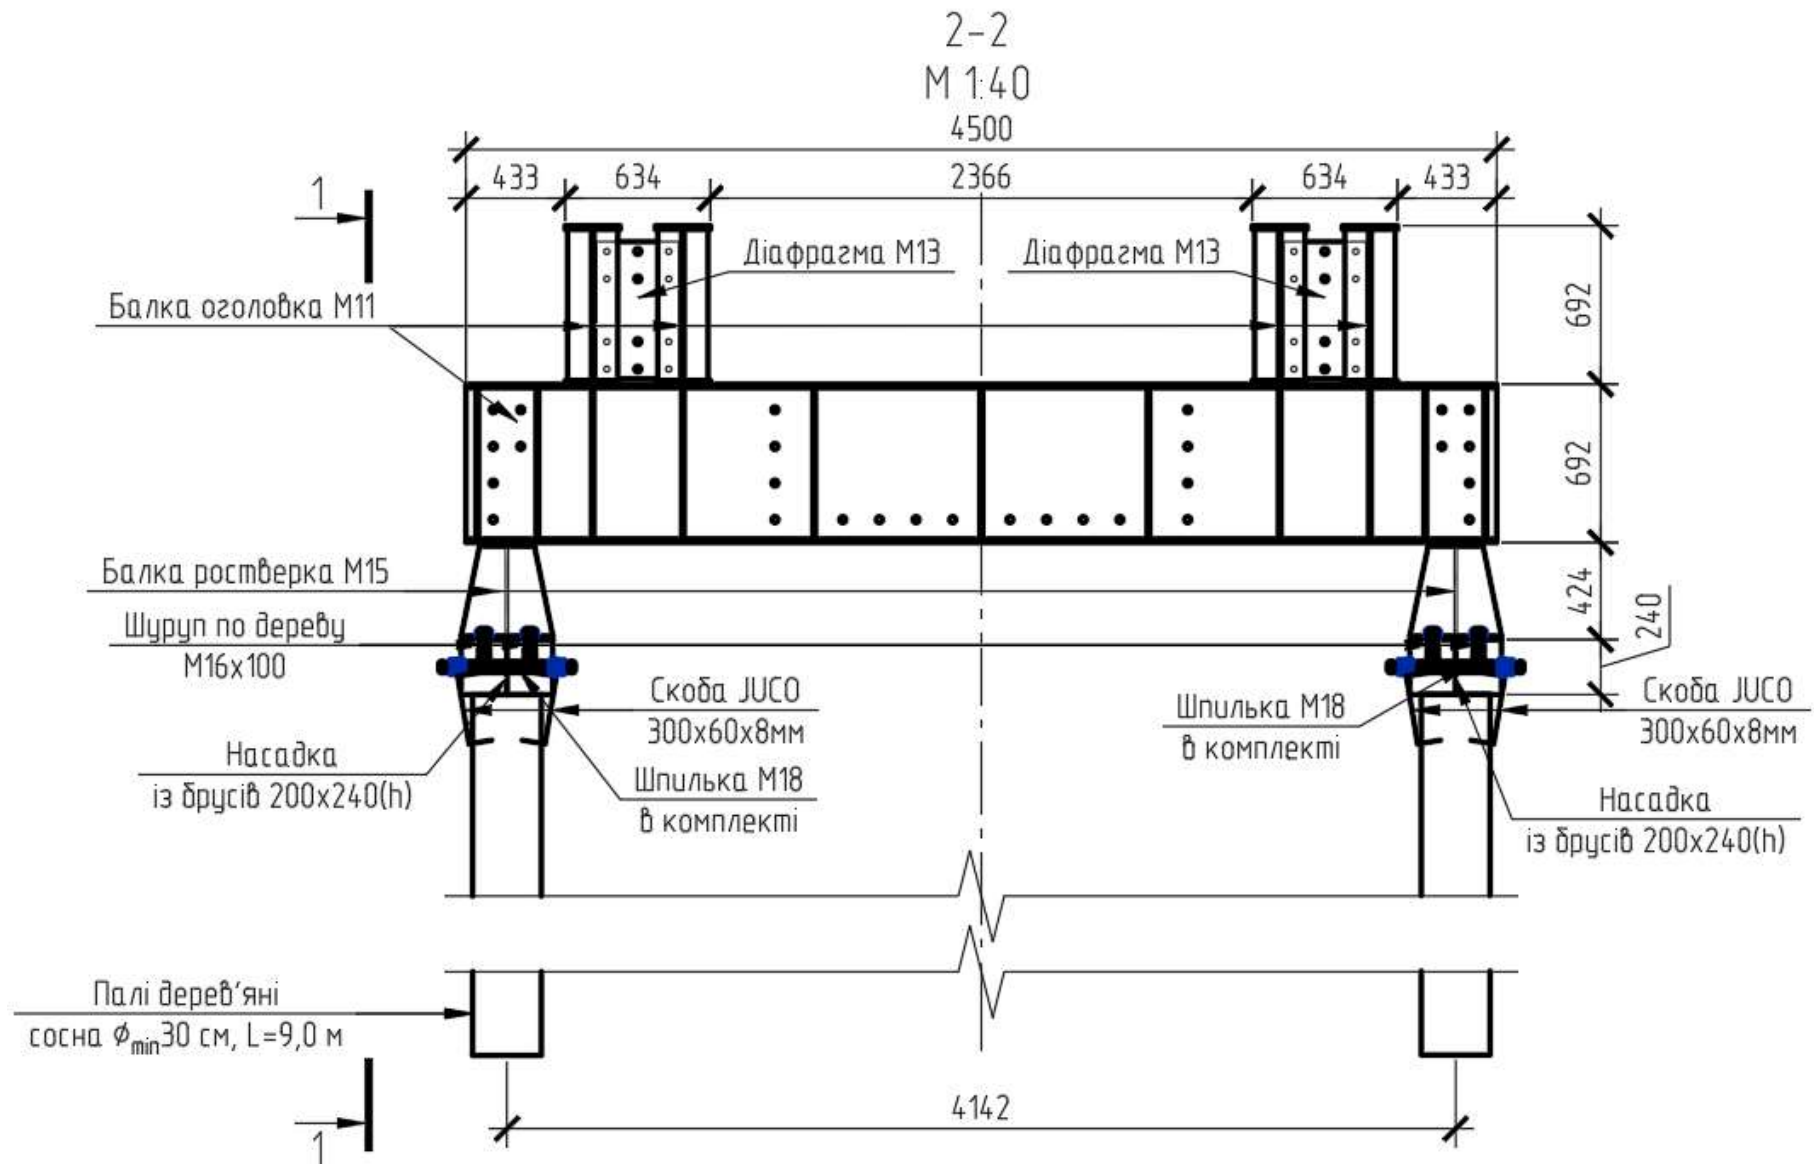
Влаштування надбудови опори з інвентарних конструкцій ИМИ-60. Переріз 2-2.
